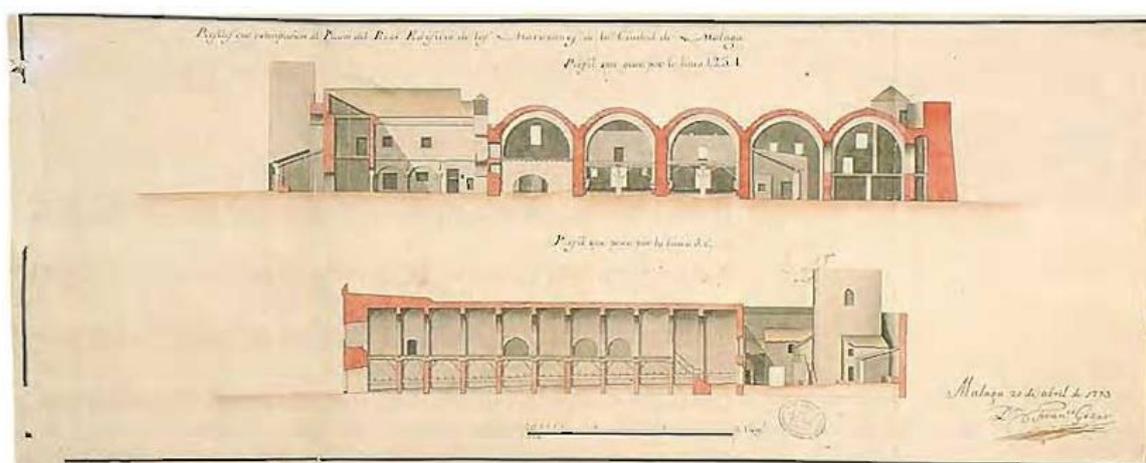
Perfil y planta de las Atarazanas de Málaga¹³
